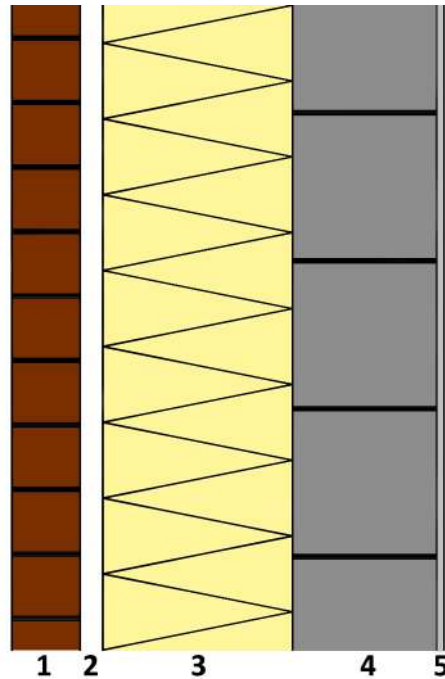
Détail technique paroi traditionnelle (échelle 1.10)
